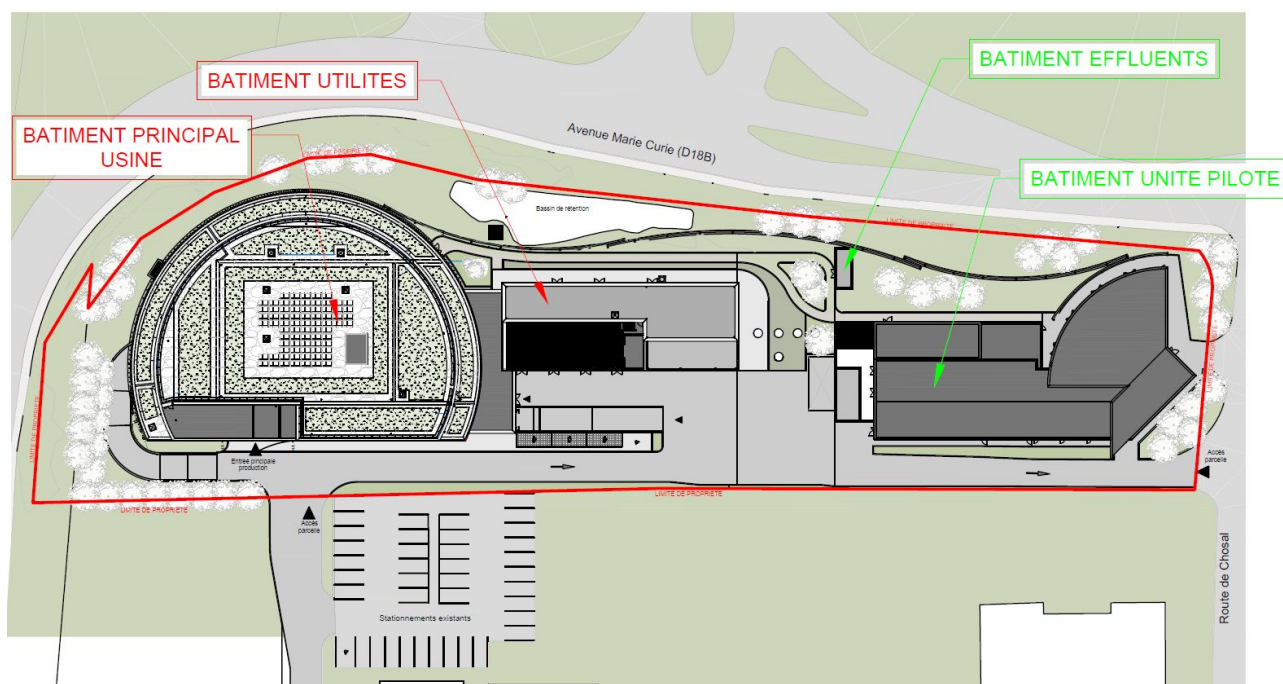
Plan du site avec en vert les bâtiments existants et en rouges les bâtiments construits dans le cadre du projet (Source : dossier)
